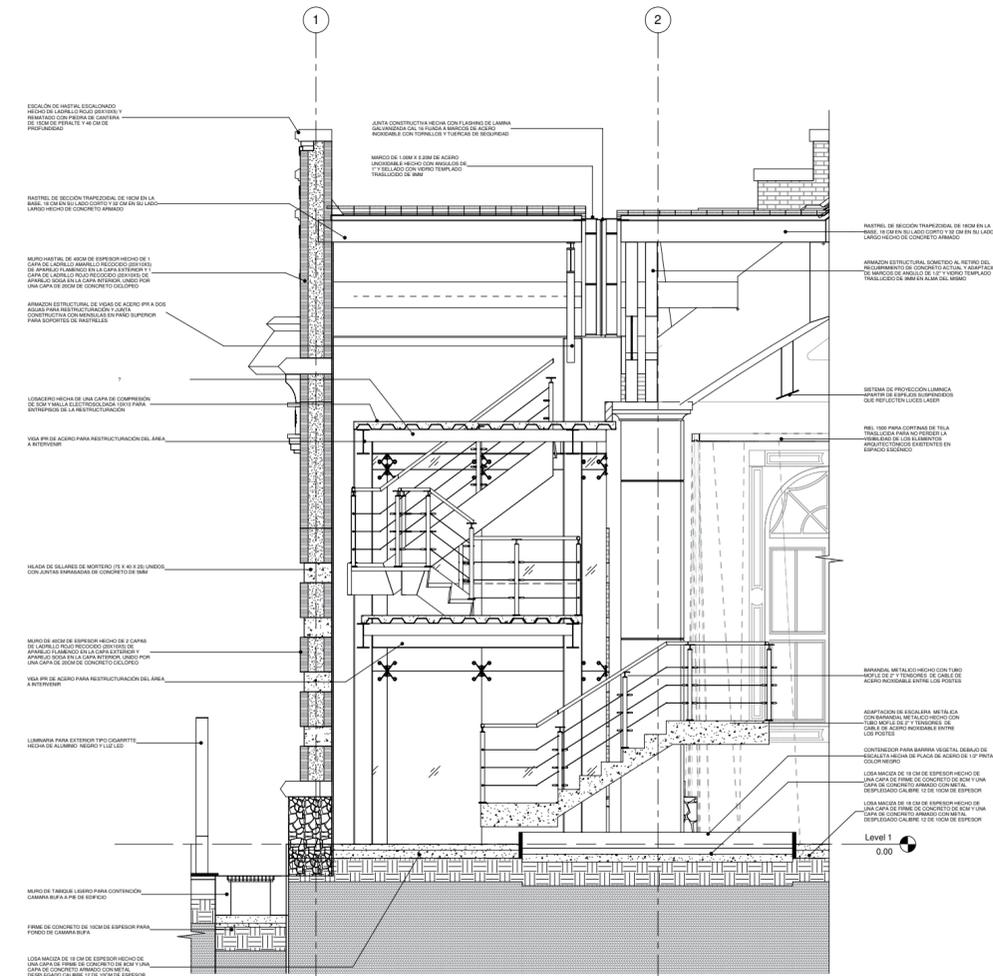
Corte por fachada - Reestructuración Casa de Bombas #3.
